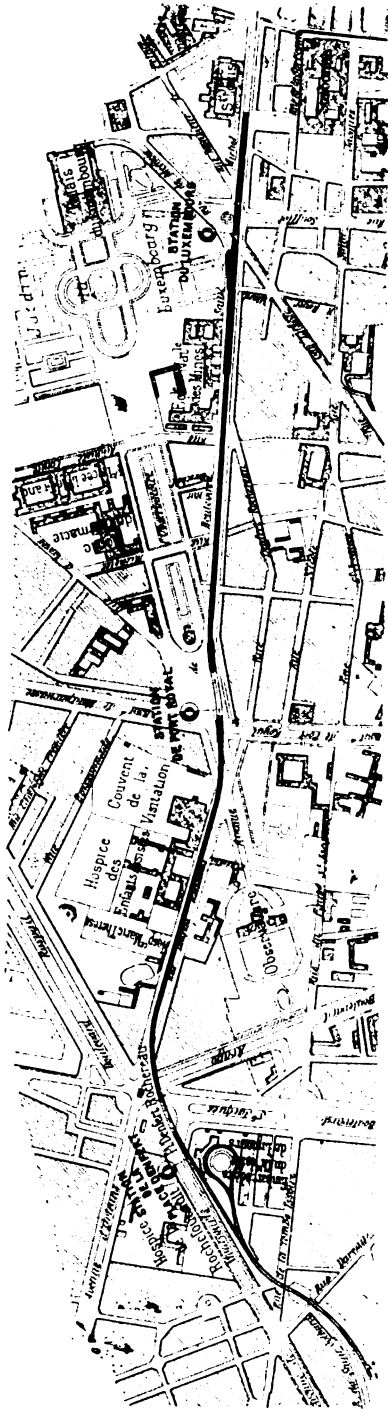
Plan général du prolongement métropolitain de la ligne de Sceaux.
